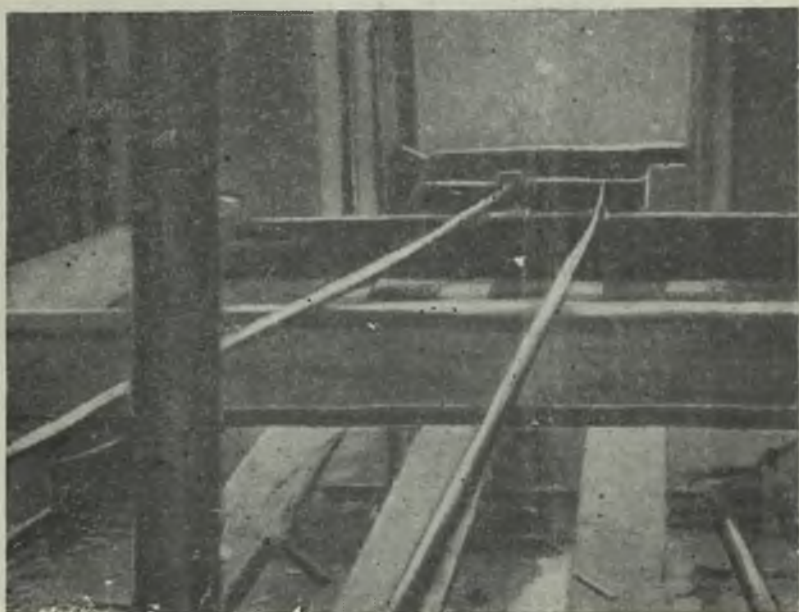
Тяги домкрата, закрепленные на стене дворового фасада.
